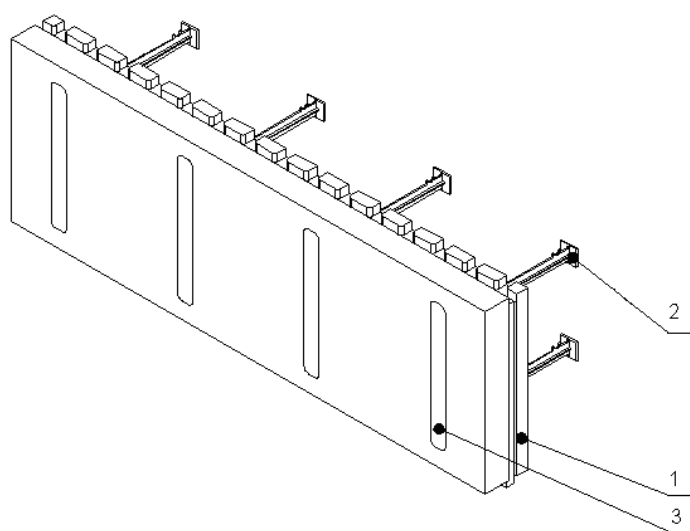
Теплозвукоизоляционная фасадная плита
